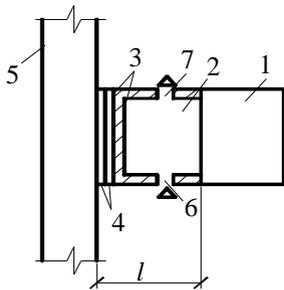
Схема закрытой отступки: 1 – отопительная печь; 2 – отступка; 3 – стенка из кирпича толщиной 1/4 кирпича; 4 – дополнительная защита от возгорания материала стены (2 слоя строительного войлока, пропитанного глиняным раствором); 5 – стена, выполненная из сгораемого материала; 6 – отверстие в нижней части стенки, закрываемое жалюзийной вентиляционной решеткой для вентиляции с площадью живого сечения не менее  $150 \text{ см}^2$ ; 7 – отверстие в верхней части стенки для вентиляции, закрываемое вентиляционной решеткой с площадью не менее  $150 \text{ см}^2$
